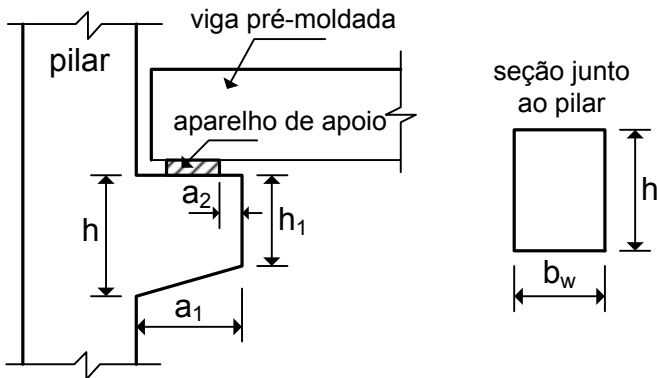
Viga pré-moldada apoiada em consolo curto
